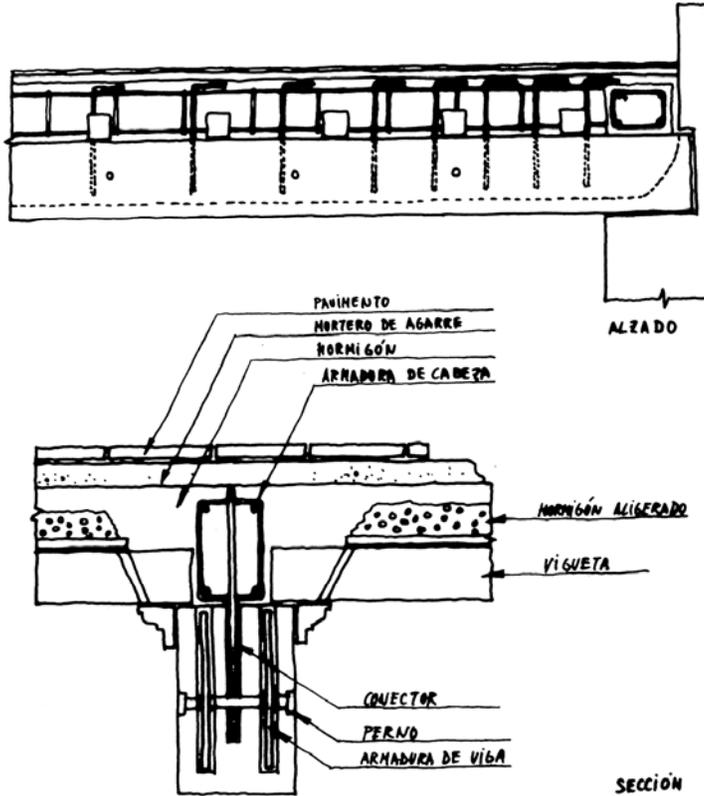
Refuerzo de una viga de madera con una cabeza de hormigón comprimida y una armadura de placas de acero en la zona traccionada.
